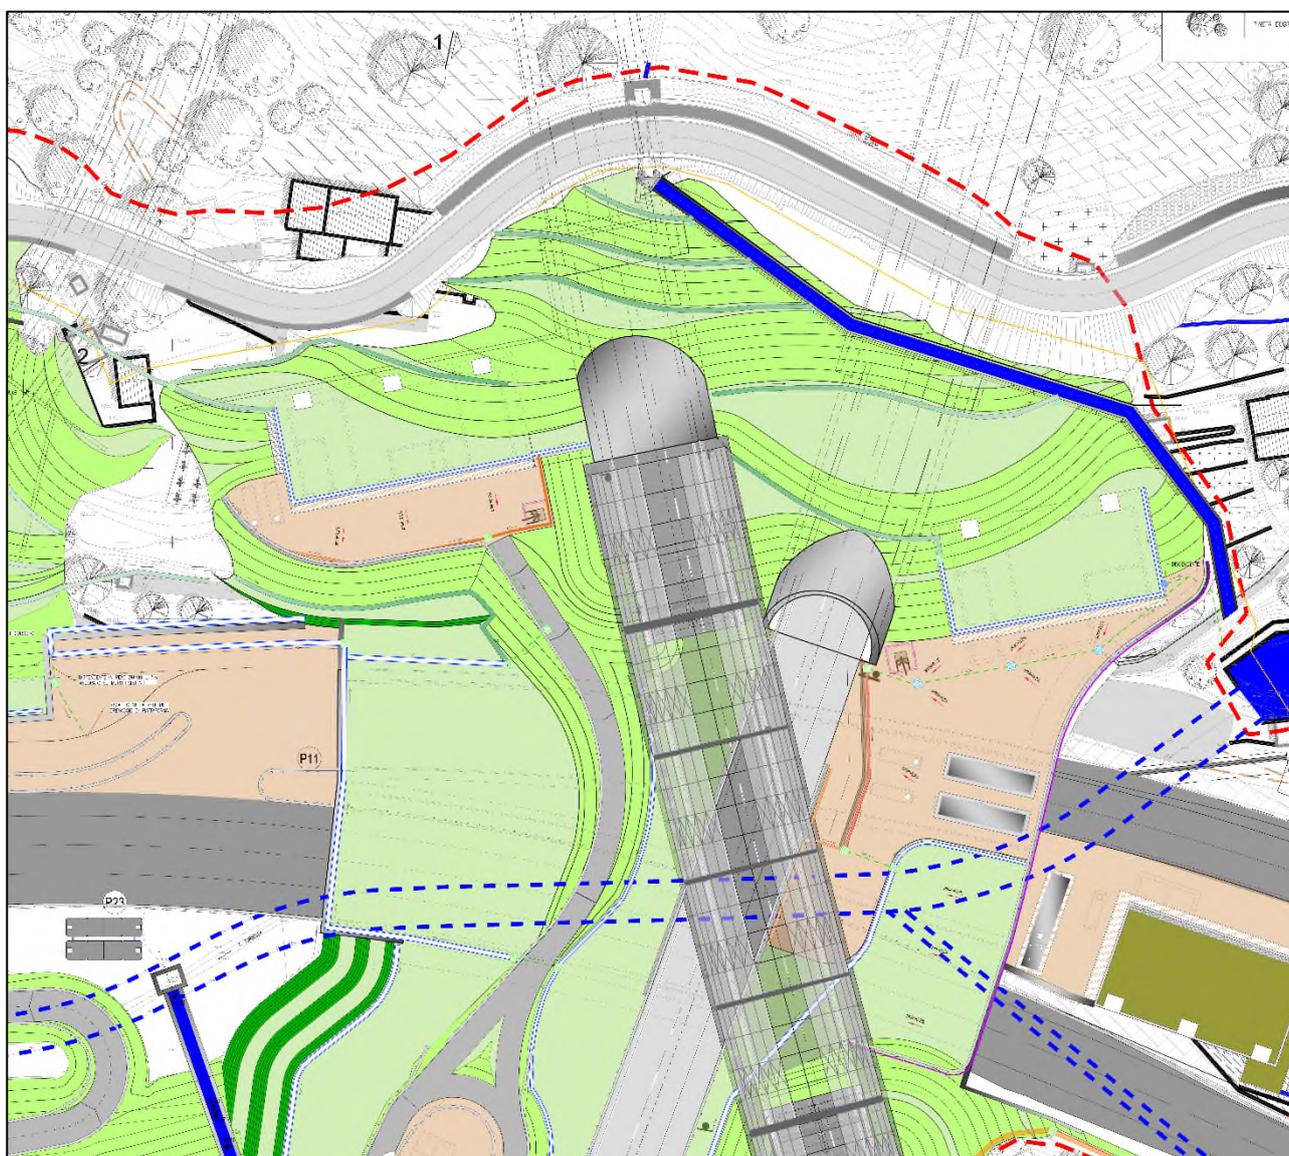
Planimetria finale dell'area d'imbocco (fonte: elaborato 110721-LL03-PE-A2-G11-GF11S-SSF00-D-AUA0521-2)
